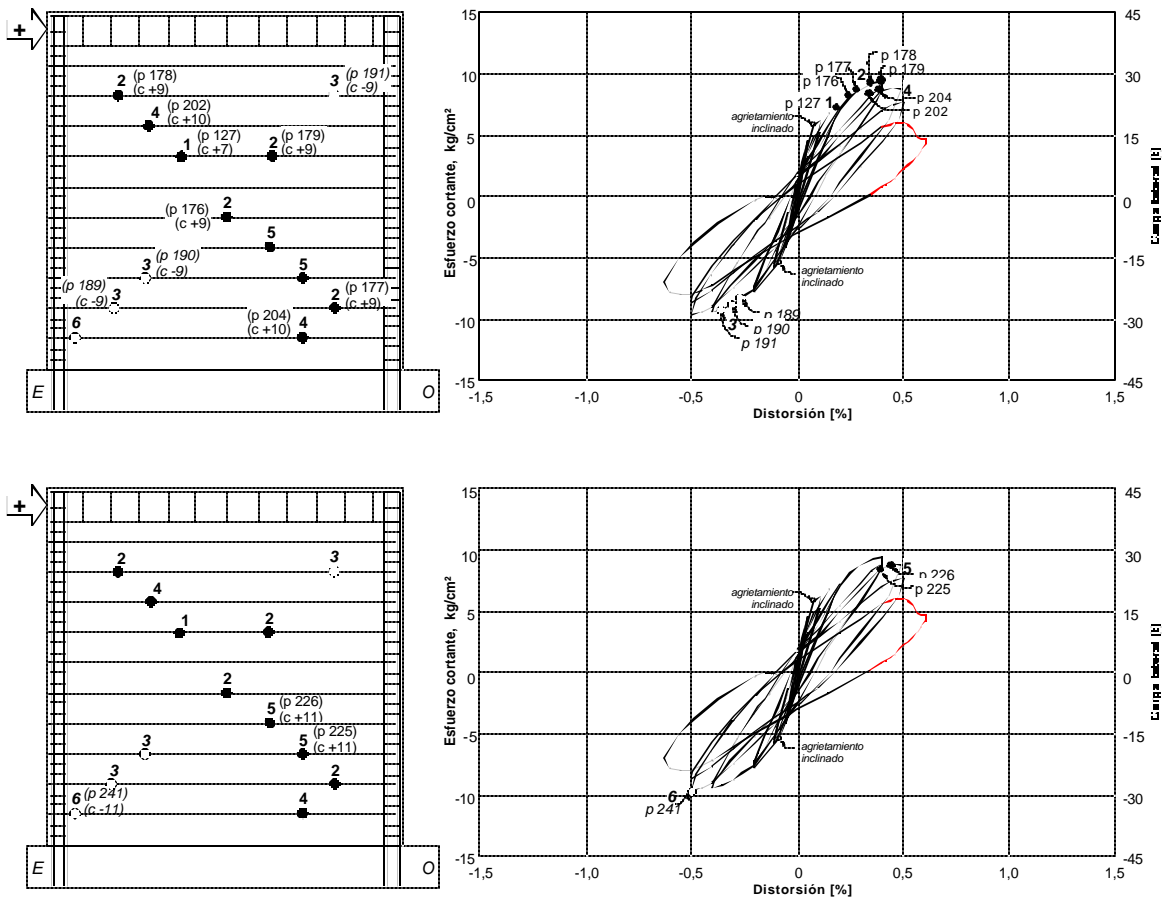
Secuencia de fluencia del refuerzo horizontal del espécimen N2
